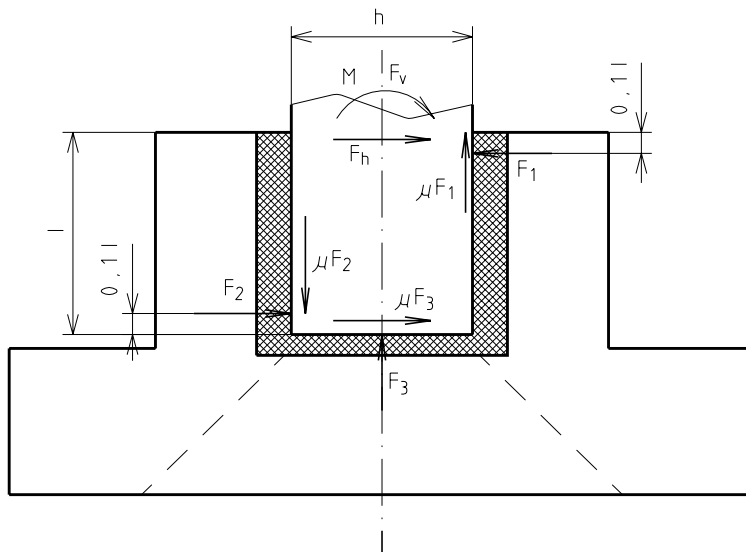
a) : Encuvement avec joint à parois nervurées
